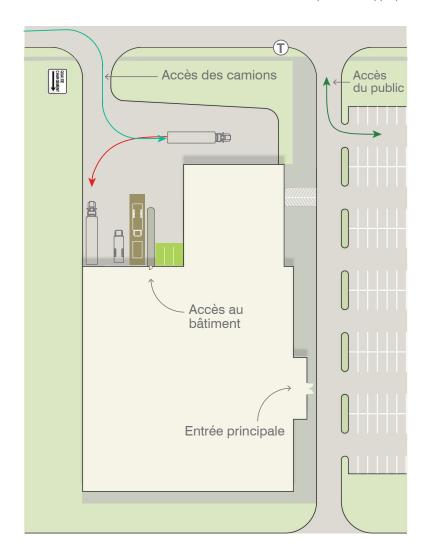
Exemple de conception d'un site d'immeuble à bureaux
